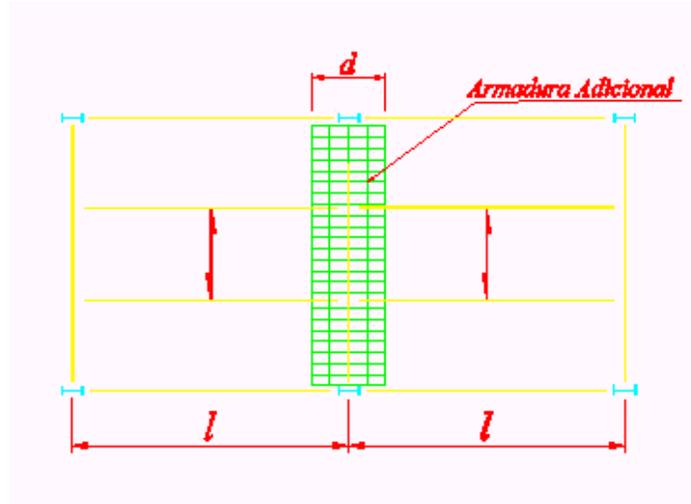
Armadura de fissuração na ligação das vigas secundárias (em planta) – CODEME¹⁸
